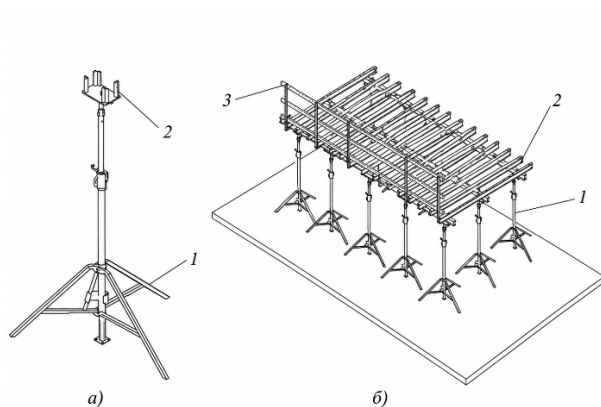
Телескопічна стійка опалубки перекриття та схема встановлення опалубки перекриття:
